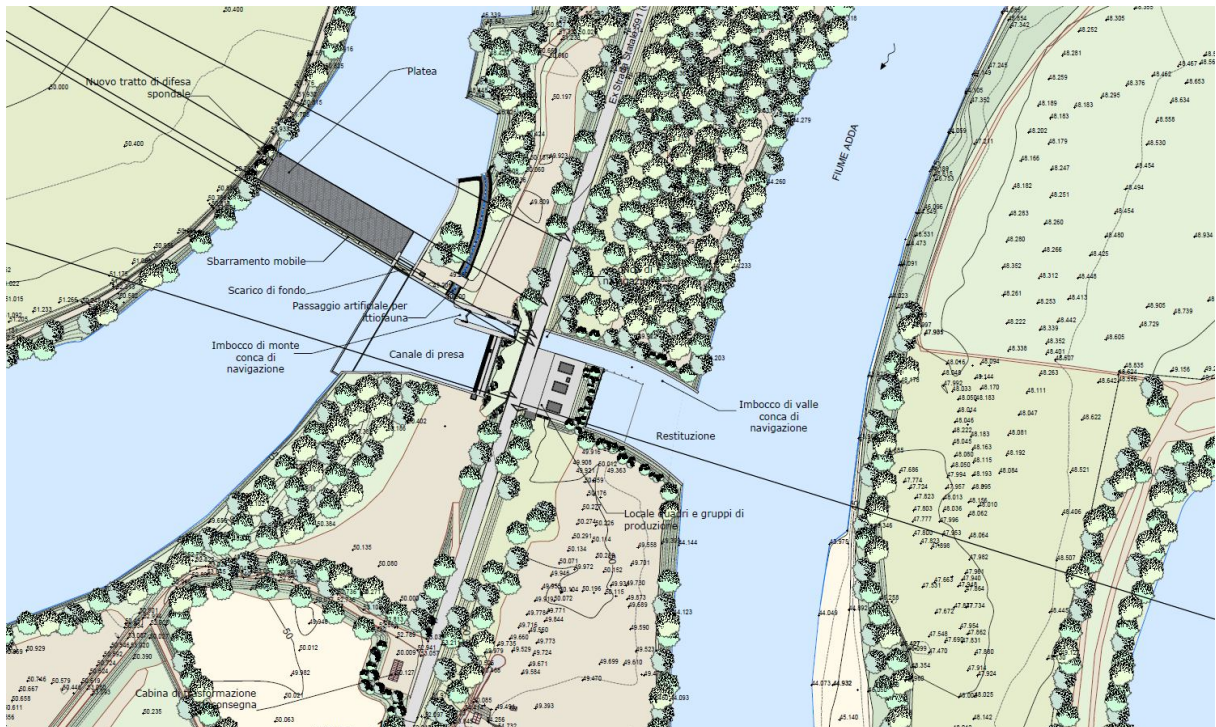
Planimetria generale dell'area di intervento - situazione in progetto
